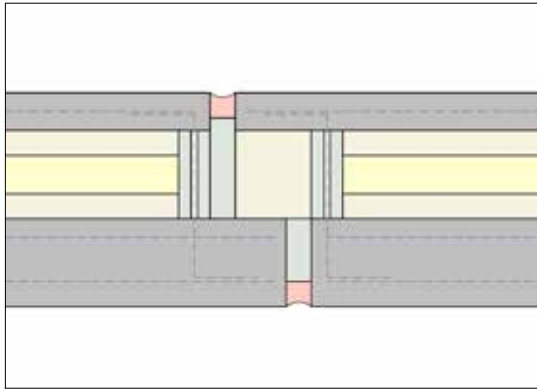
Fassaden-Sandwichelemente (FSE), Bauteilstoß / Vertikale Fuge (kbp)
